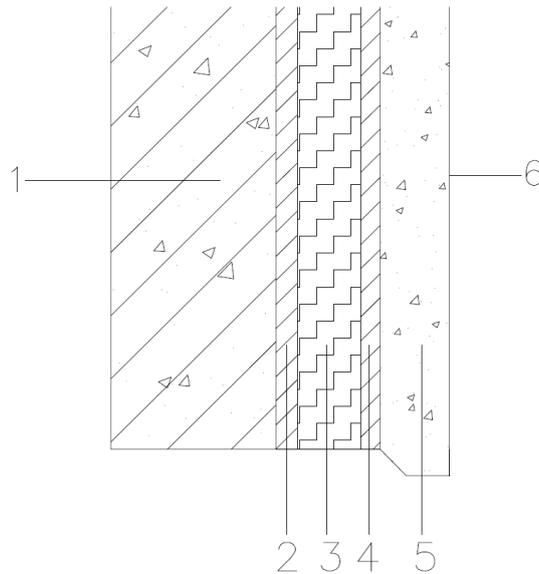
预制混凝土夹心保温墙板构造示意图
